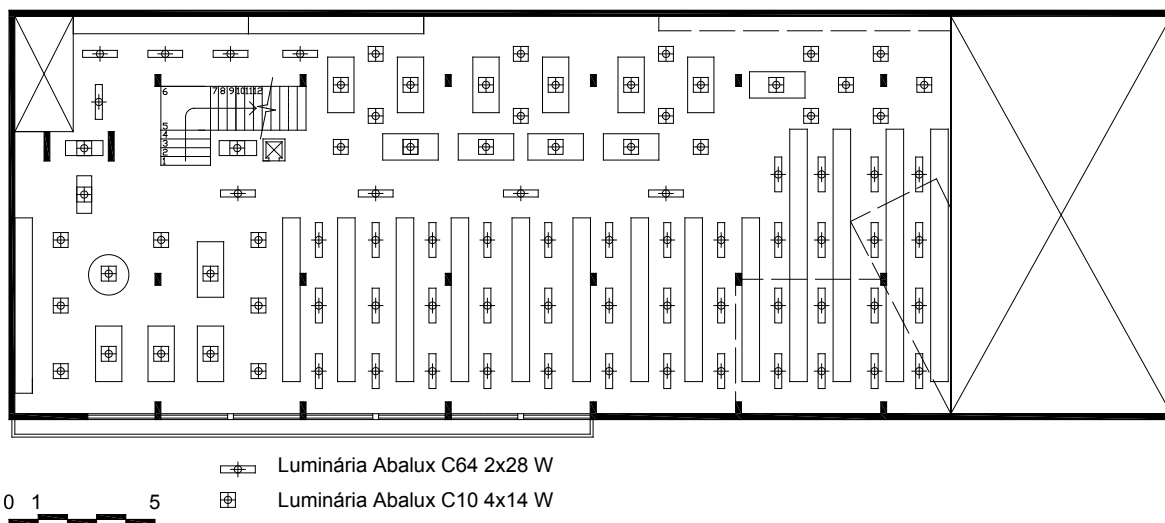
Layout da planta-baixa com a distribuição dos pontos de iluminação calculados.
